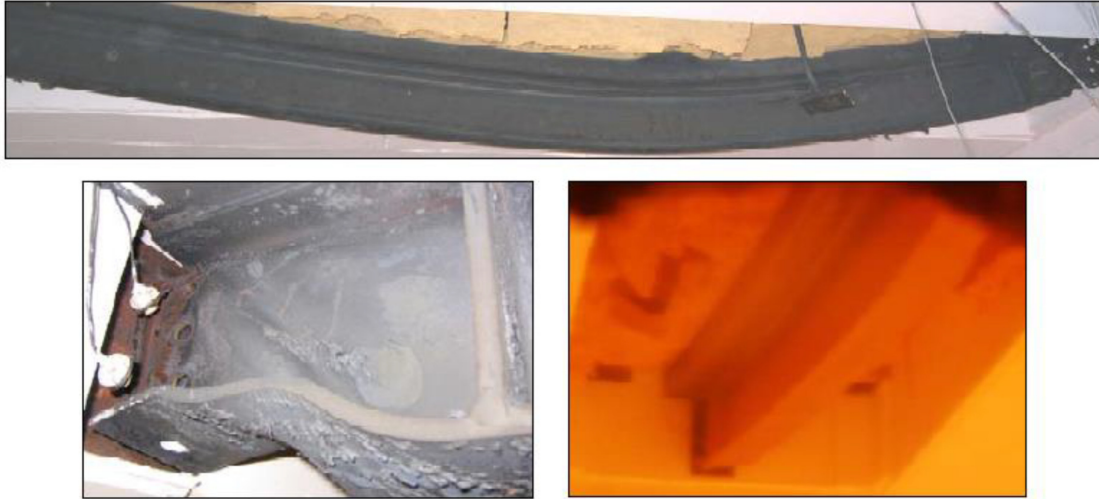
Deformação da viga e da ligação nos ensaios de Wald (SARRAJ, 2007).
